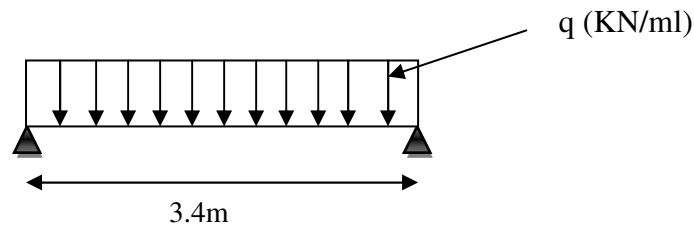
Schéma statique de la poutre palière de l'étage courant
